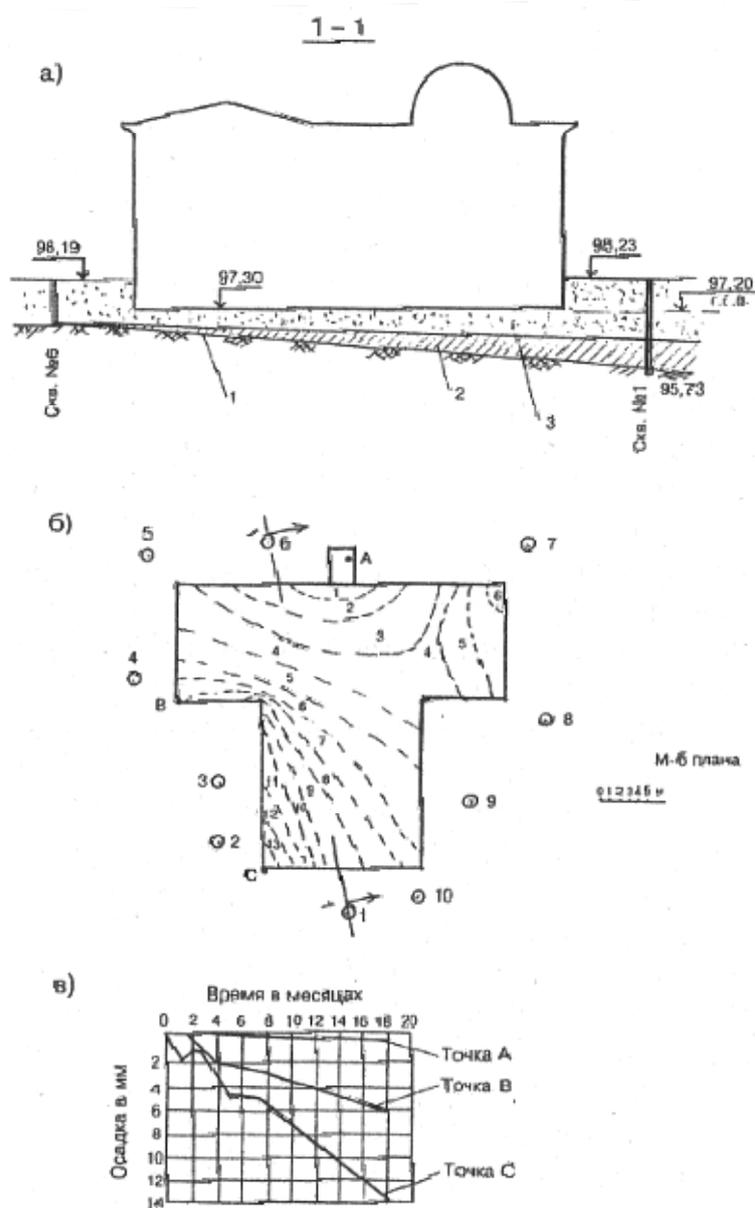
Осадка здания водолечебницы: а – характер грунтов под зданием (разрез 1-1); б – график осадок в плане здания; в – график осадок во времени; 1 – кровля известняка; 2 – глина 3 – песок пылеватый.
